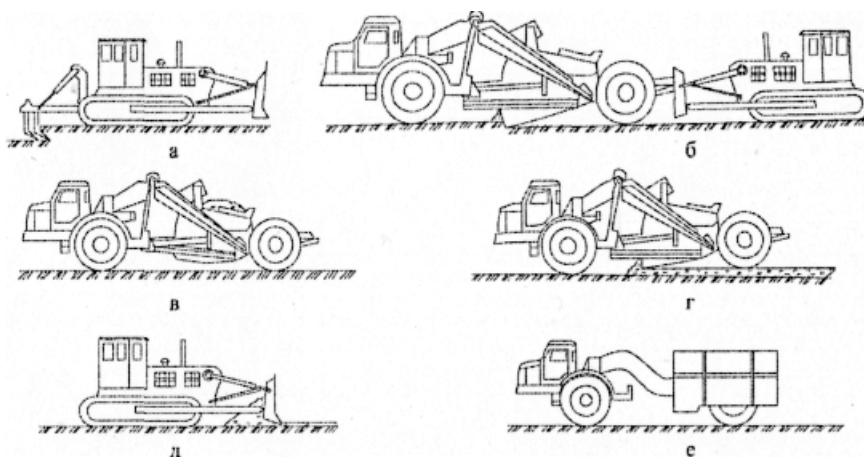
Схема комплексной механизации земляных работ при разработке грунта скрепером: *а* – рыхление; *б* – набор грунта; *в* – транспортирование; *г* – разгрузка скрепера; *д* – разравнивание грунта в насыпи; *е* – уплотнение грунта катком
